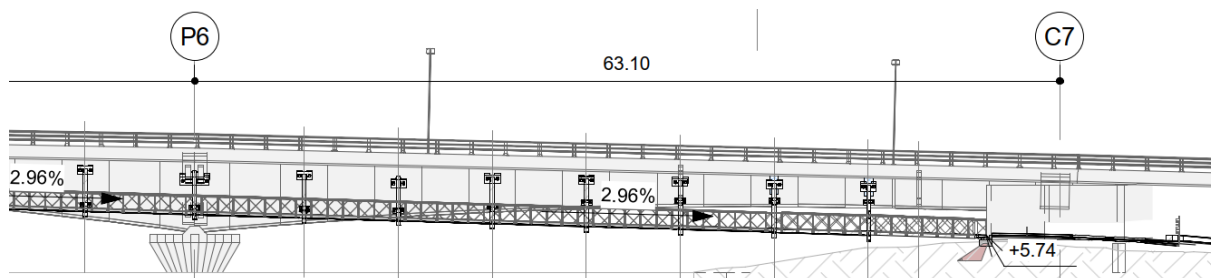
Consoles accrochées latéralement au pont sur la travée de rive T7 - Extrait du cahier de plans PRO
